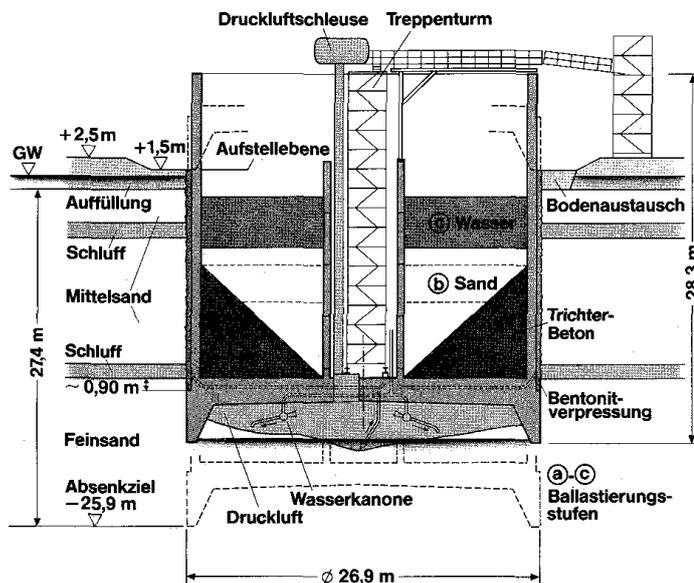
Schnitt durch einen Druckluftsenkkasten [2]
